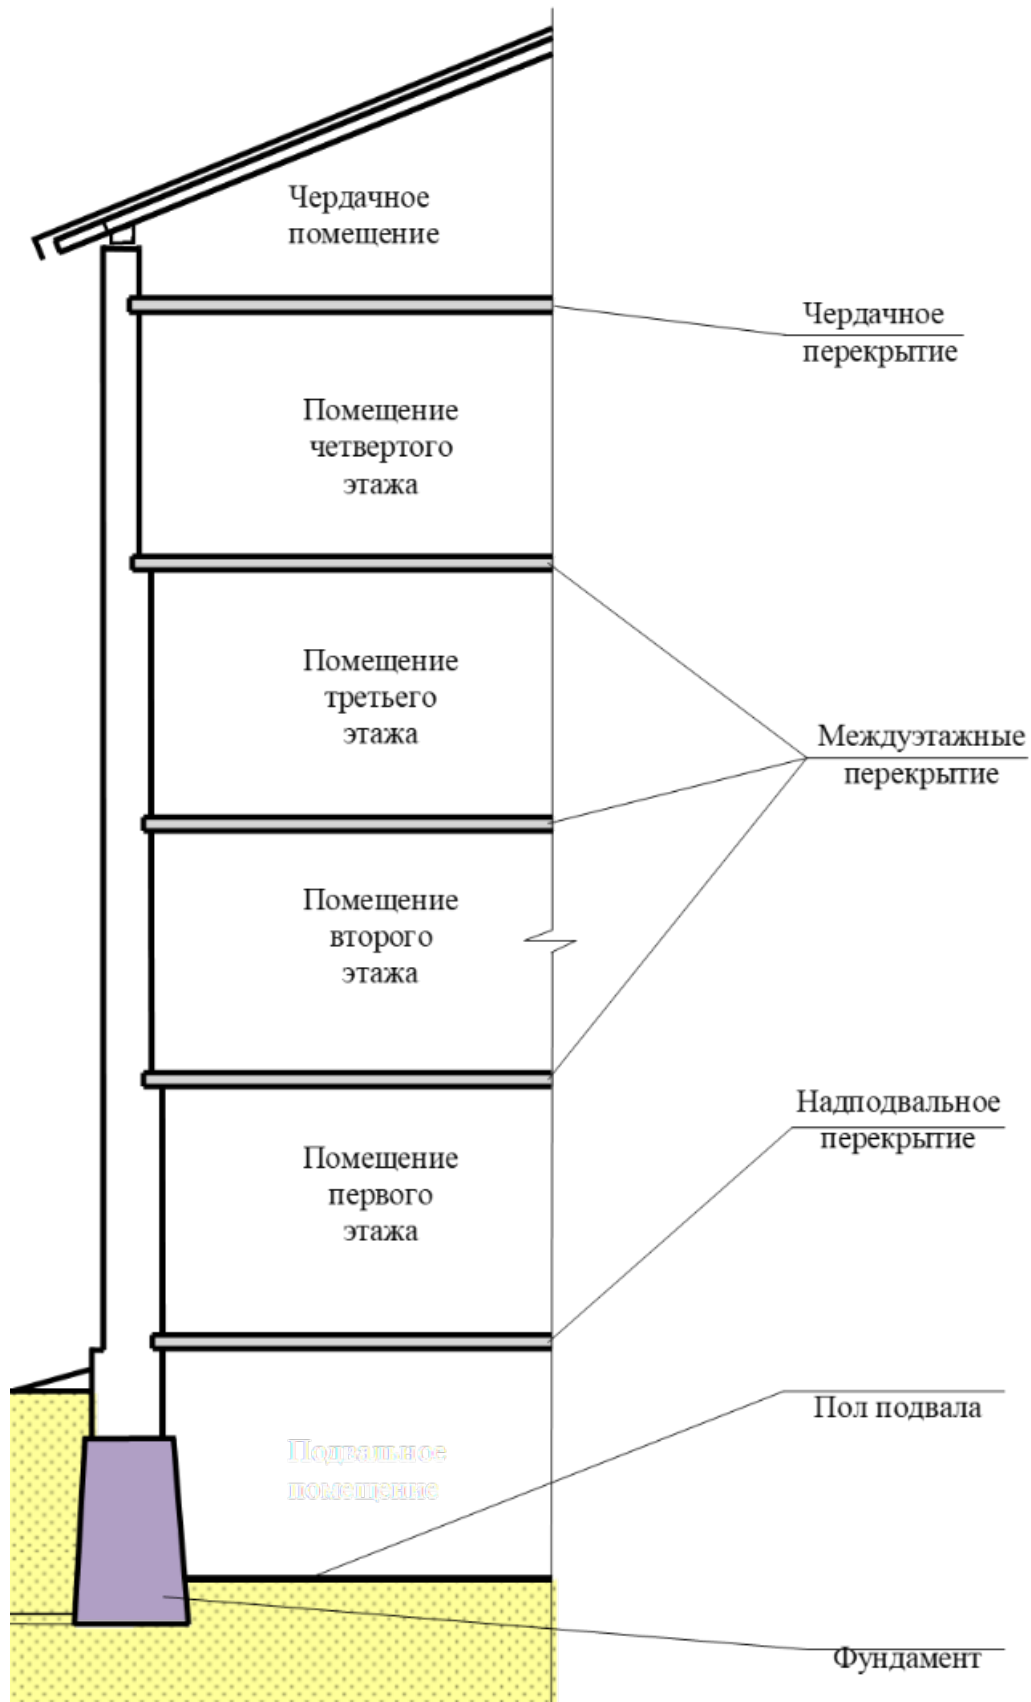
Схема конструктивных элементов (разрез по наружной стене) исторического здания [4]
